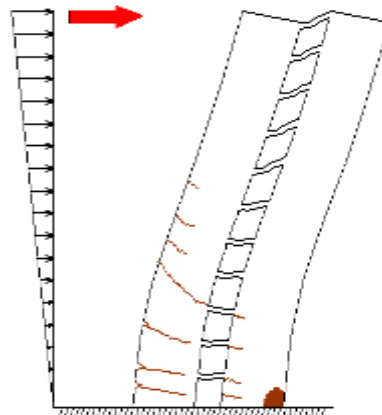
Falla por flexión en los muros de corte debido a las vigas de conexión.
